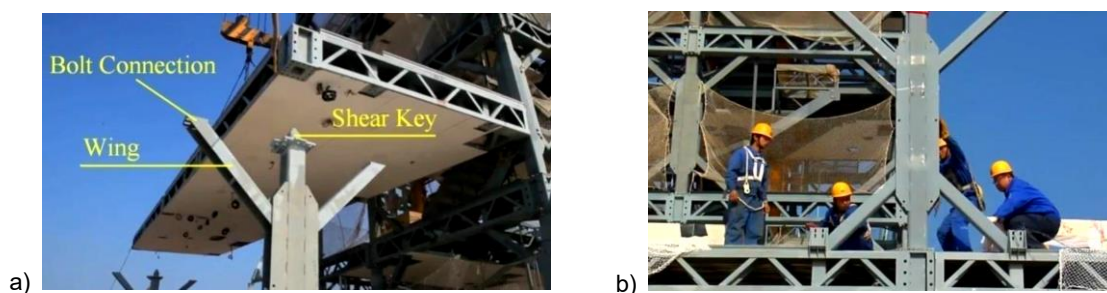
Montaje de sistema estructural panelizado de acero, conexión forjados casete – columna a) y b). Imagen del hotel Dongting Lake, Fuente: (Jackson, 2012).
